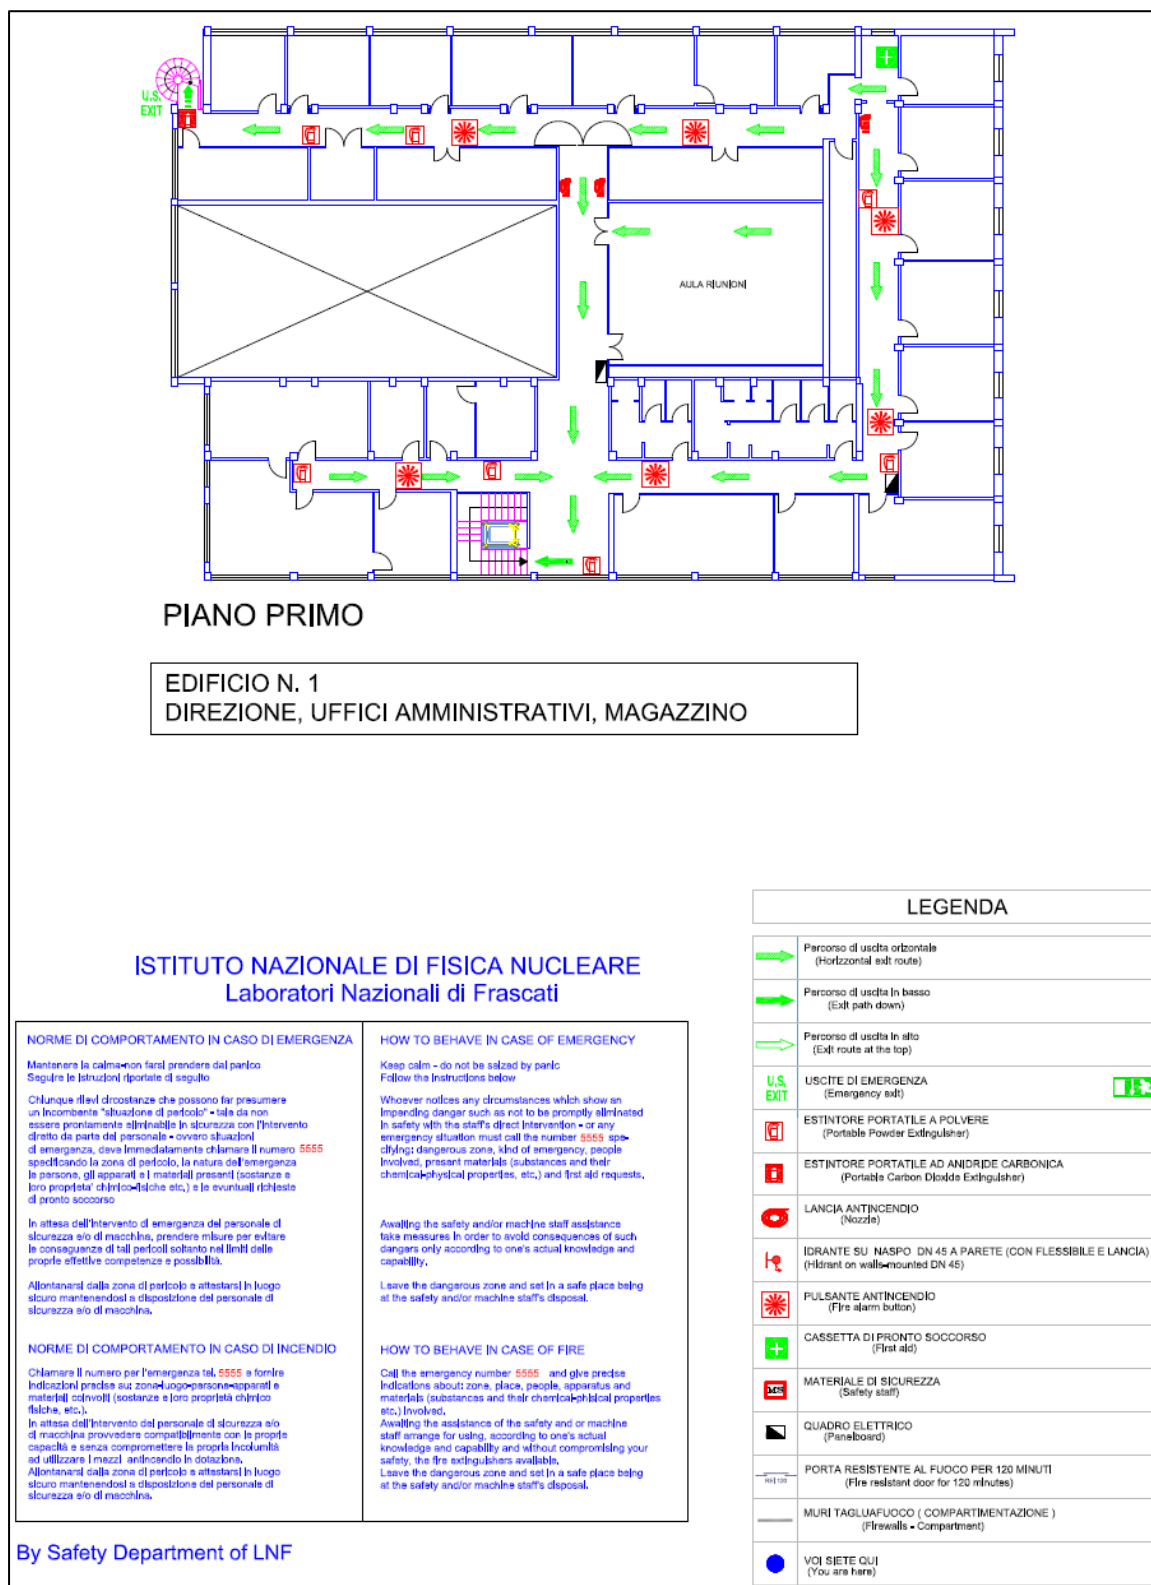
Esempio di planimetria di emergenza affissa in ogni edificio
